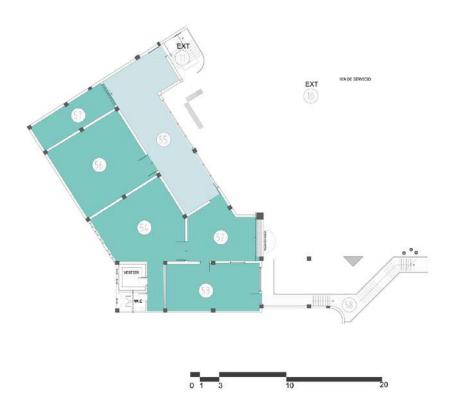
Planta -1 Bloque 44. Fuente: Equipo de diagnóstico.
